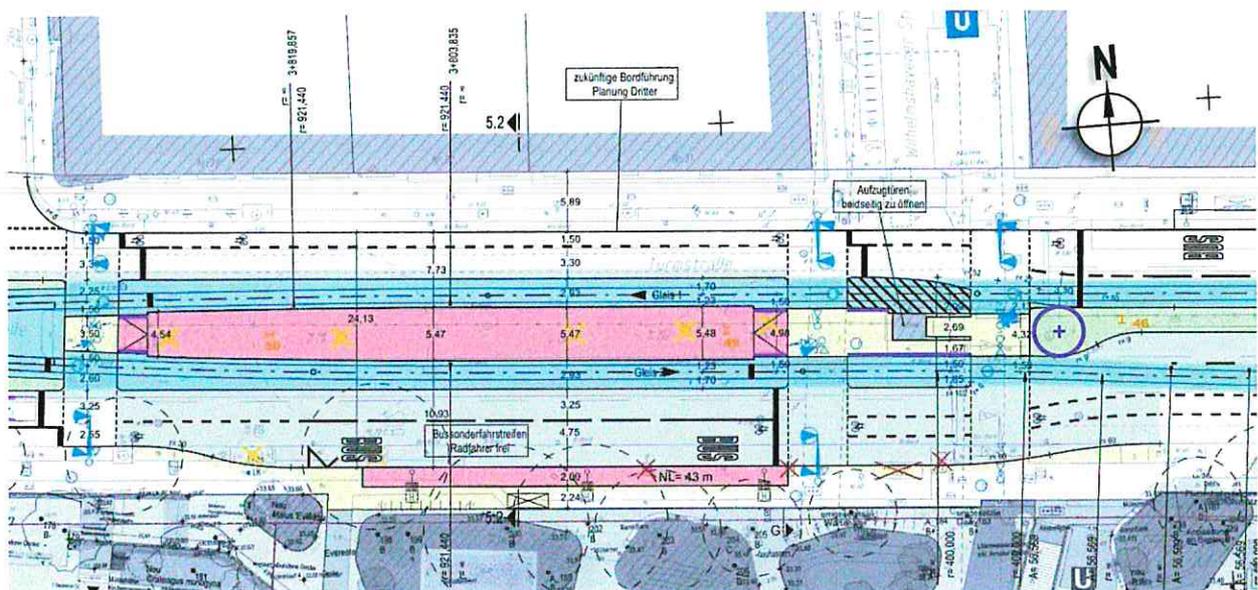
Lageplan Haltestelle U-Bahnhof Turmstraße mit zusätzlichem geplanten Baumstandort
